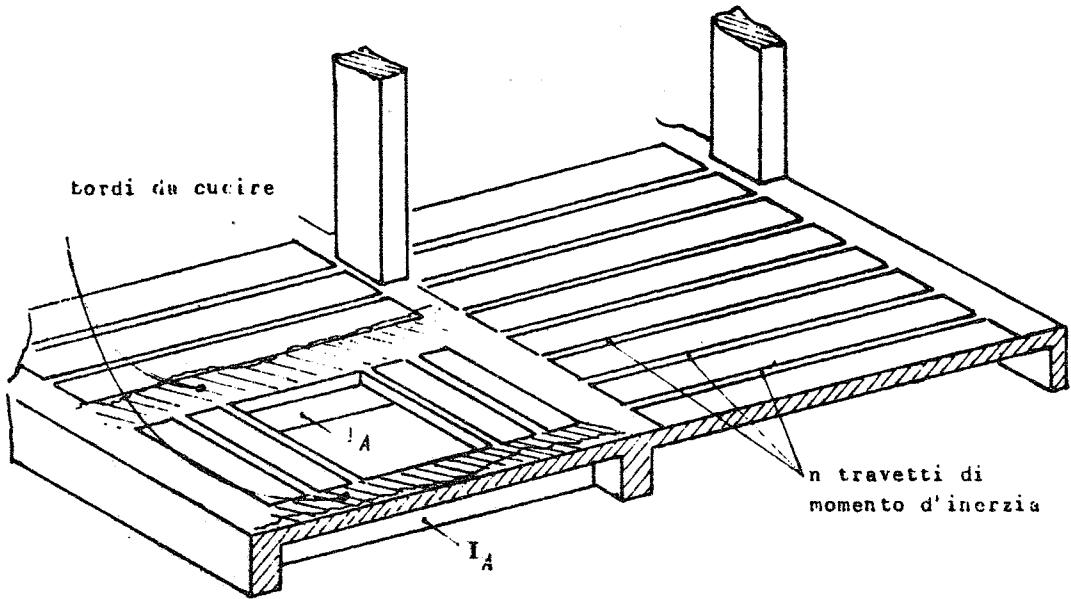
Vista prospettica della disposizione rappresentata in fig.3-8 .
